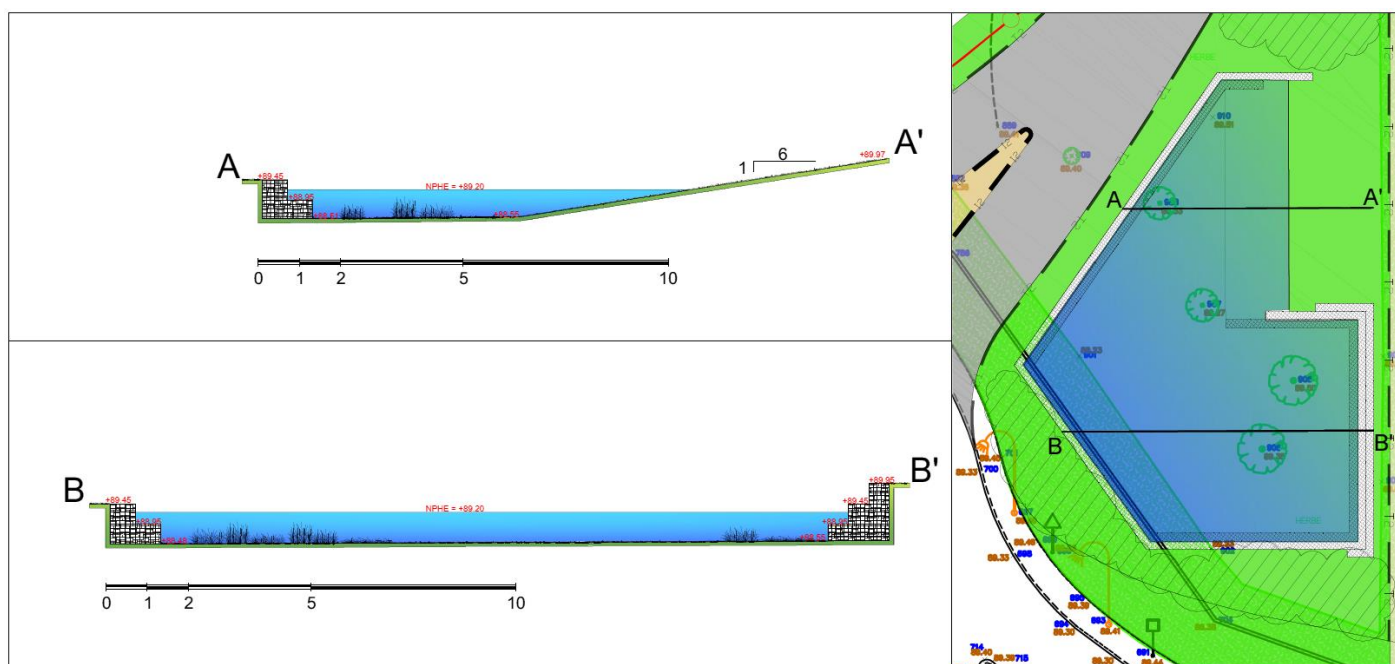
Coupe en travers du bassin de gestion des eaux pluviales
